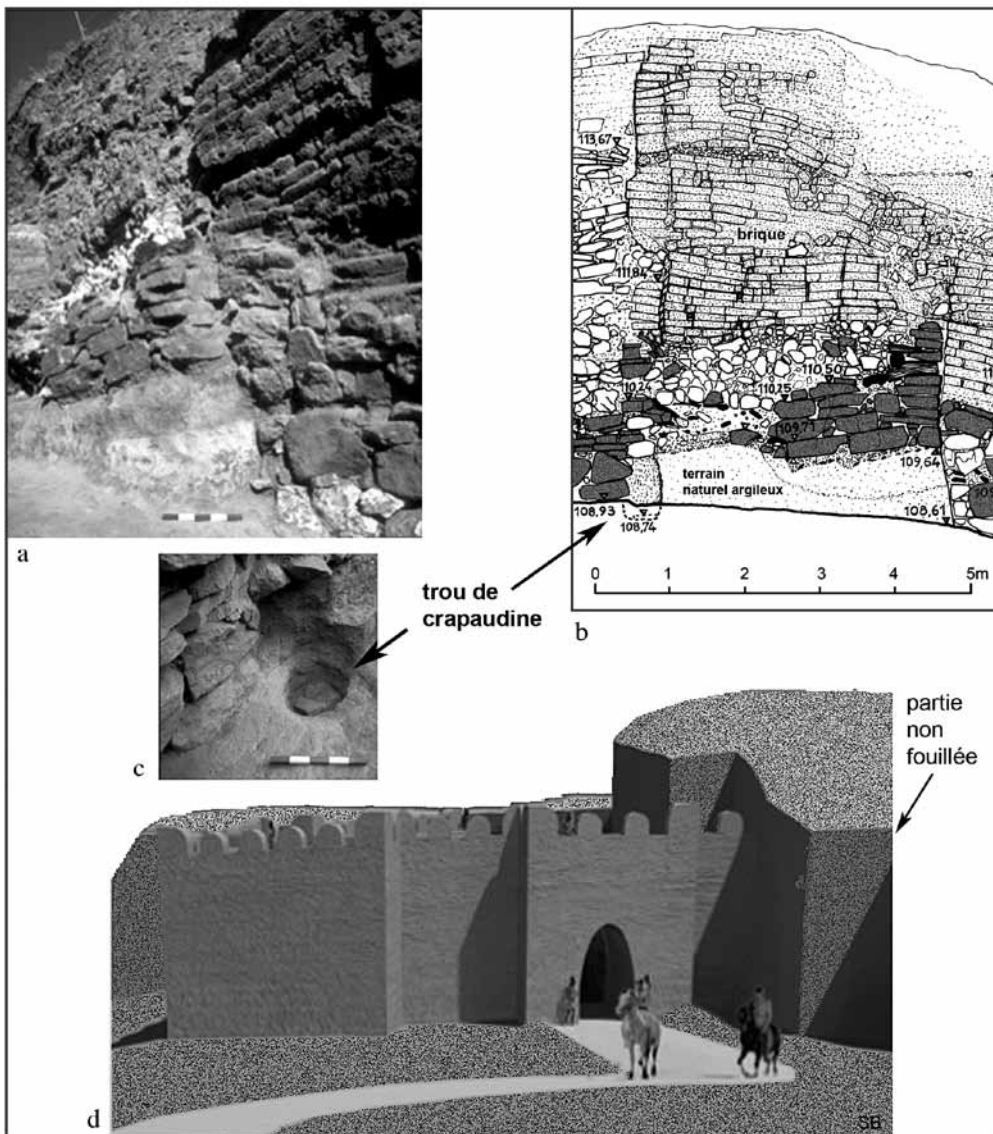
La porte primitive : a. Vue du montant sud prise de l'Ouest (cliché O. Pelon 1987) ; b. Élévation du montant sud ; c. Trou de crapaudine au Sud (cliché O. Pelon 1987) ; d. Modélisation de l'entrée et du chemin d'accès en pente descendante.
